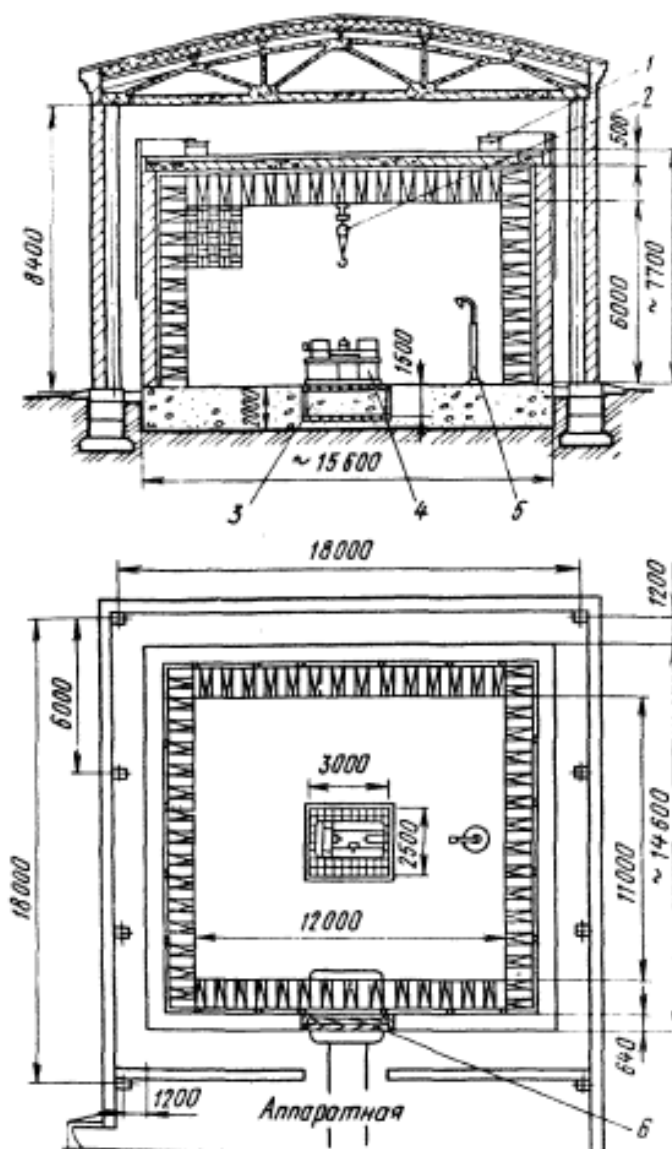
Конструкція заглушеної камери в виробничій будівлі 1 – вентиляційний затвор, 2 – електротельфер, 3 – віброізований фундамент, 4 – досліджуємий пристрій, 5 – кріплення для мікрофона, 6 – Двері.
